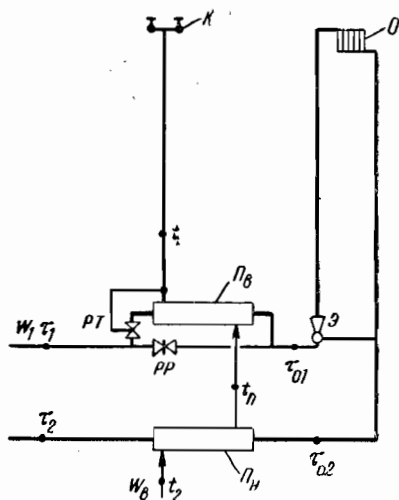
Двухступенчатая последовательная схема присоединения горячего водоснабжения и отопления.
